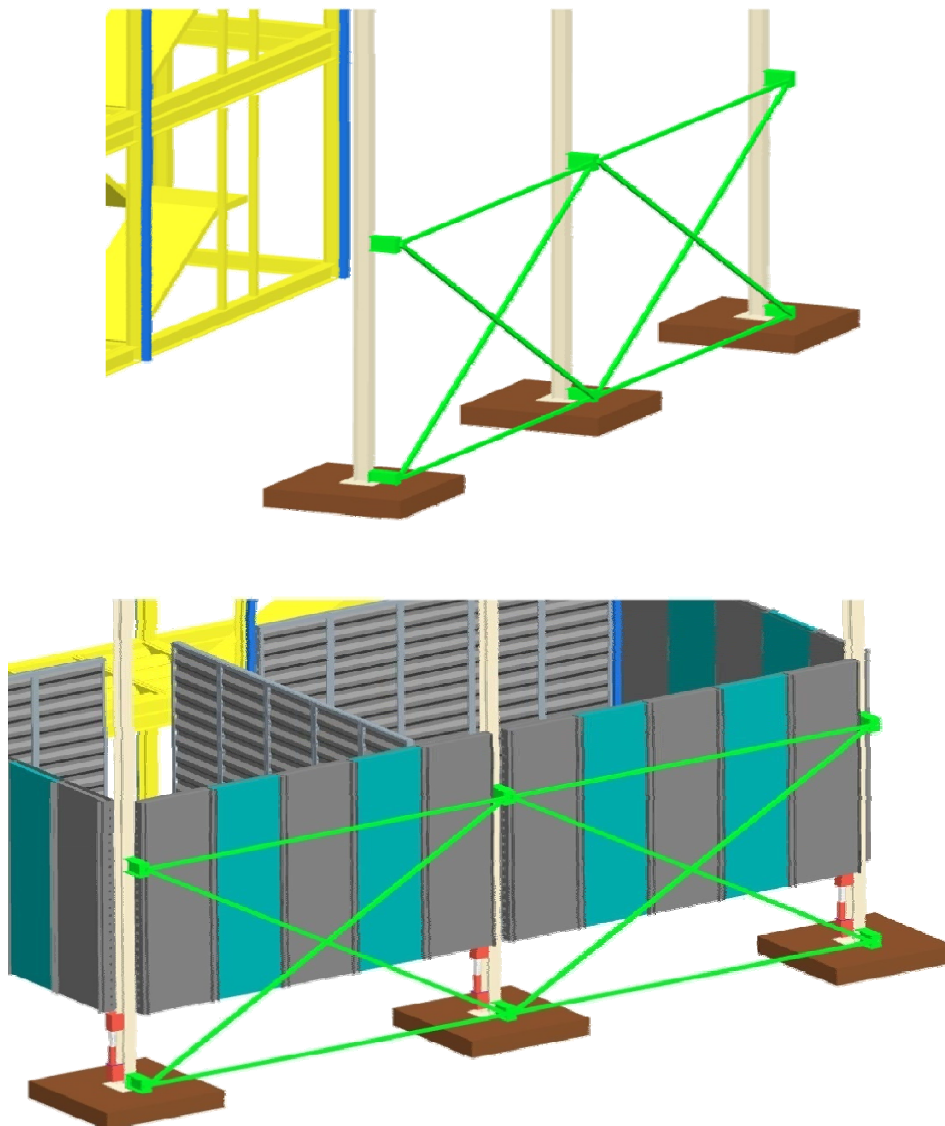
Diseño del arriostramiento para evitar interferencias con la planta
